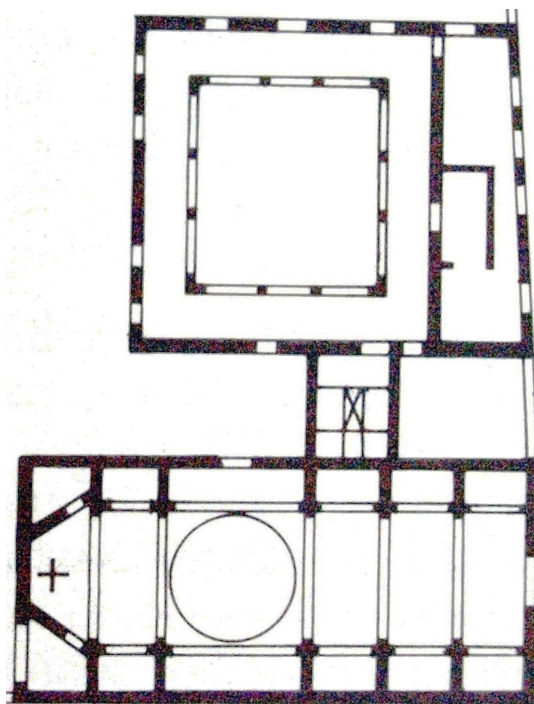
Planta del convento de Capuchinas de Alicante. Autor: M. Bevià.
